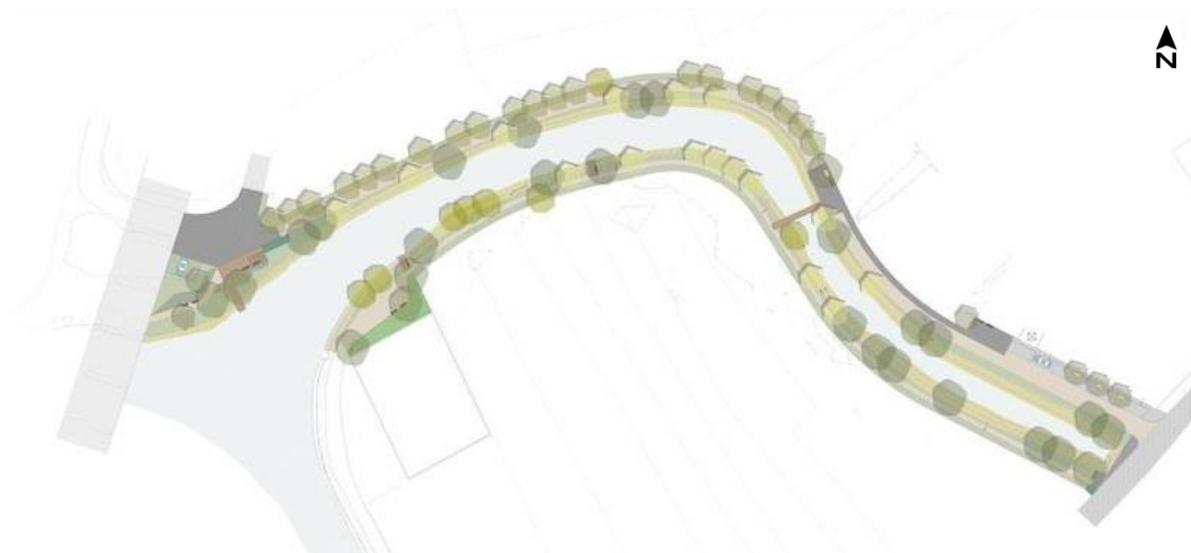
Cais de Canelas: Planta do Cais de Canelas
